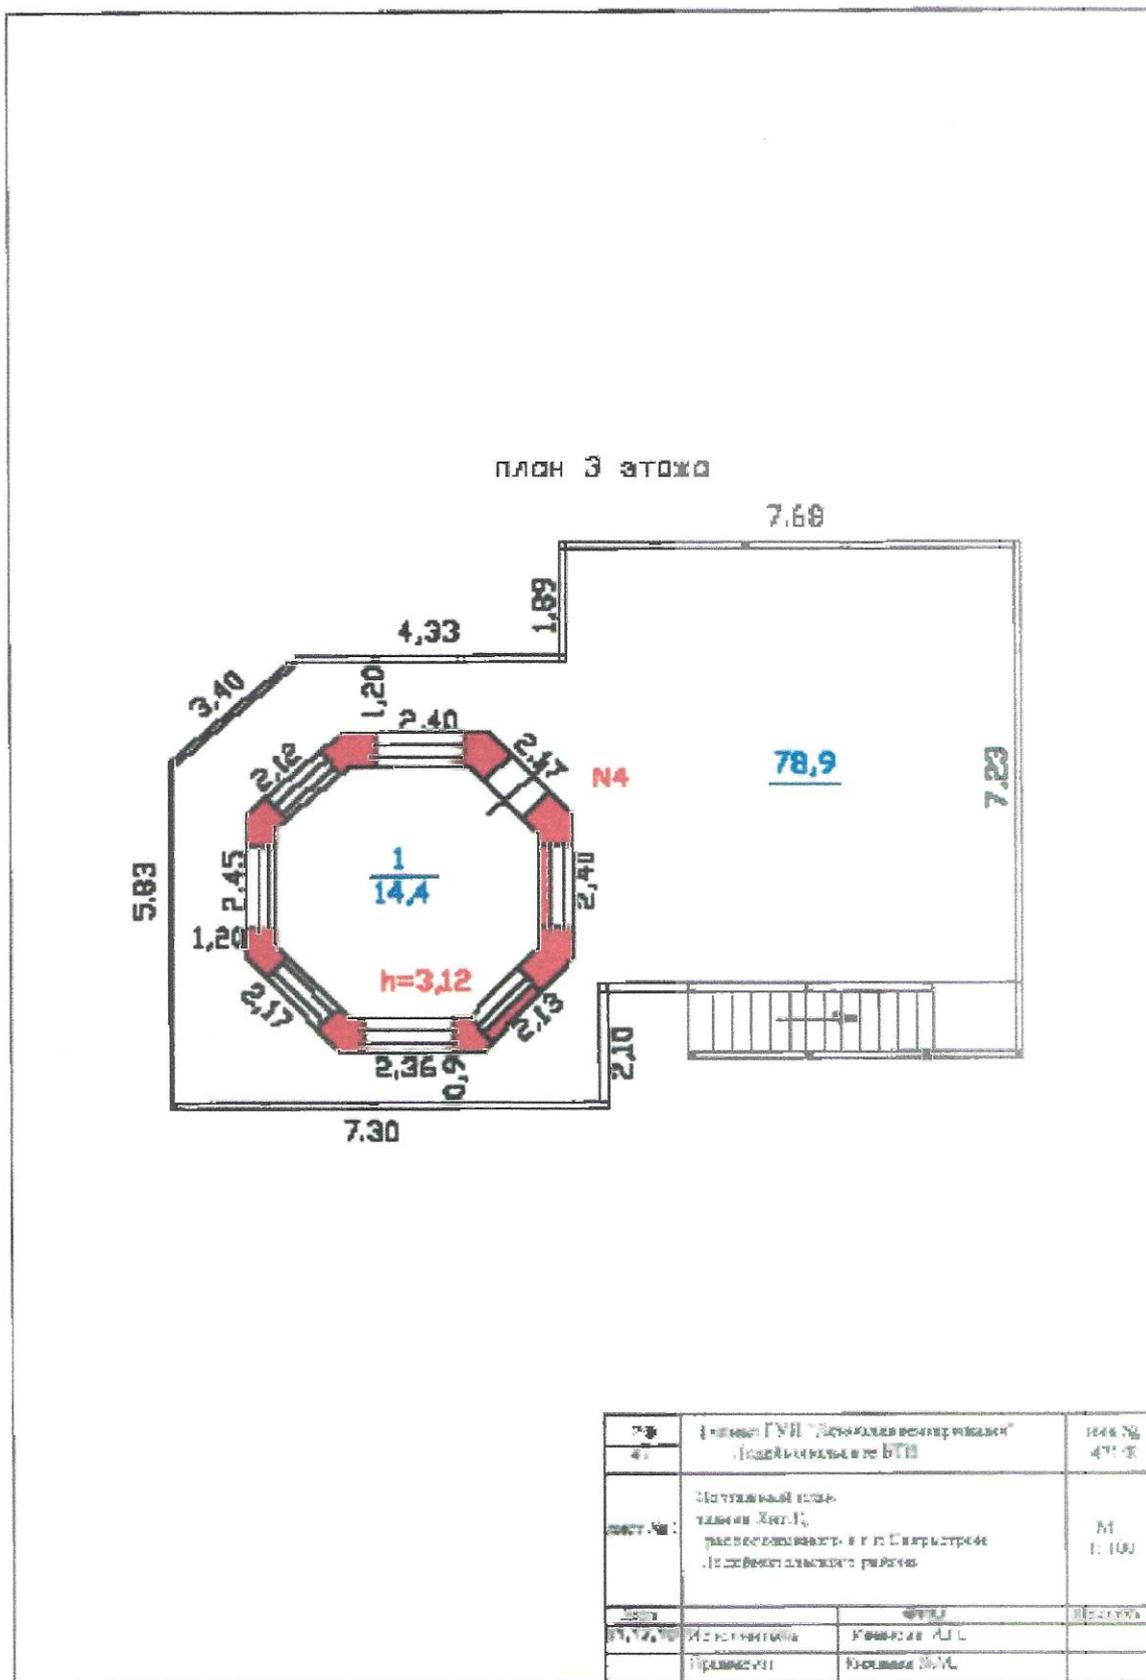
поэтажный план здания Лит. Е (3 этаж)
